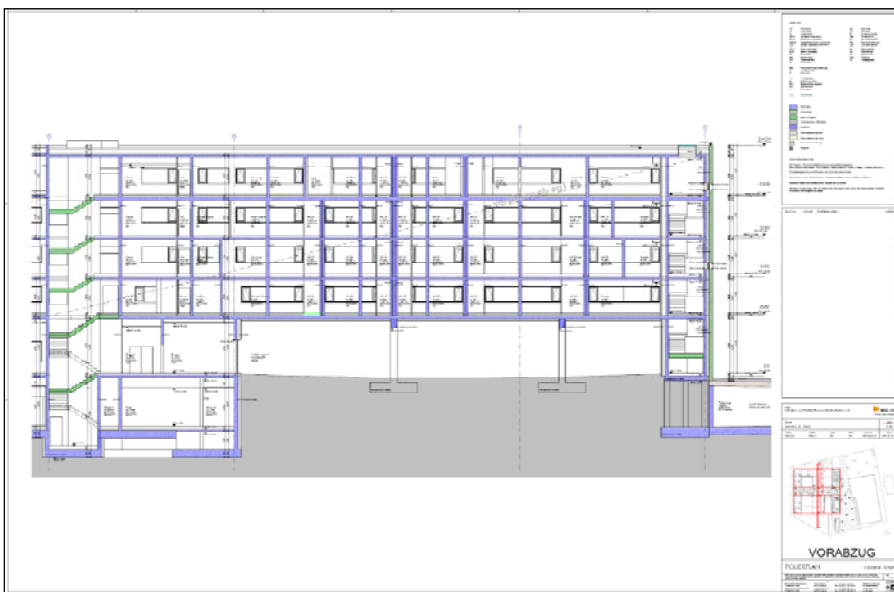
Schnitt Justizanstalt – Teil 2⁵³³
